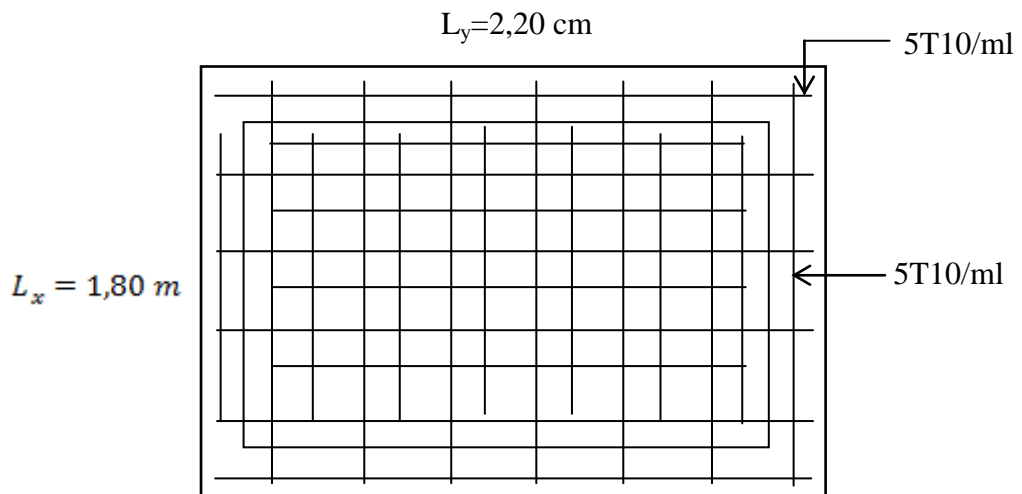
Ferrailage inférieur de la dalle de l'ascenseur
